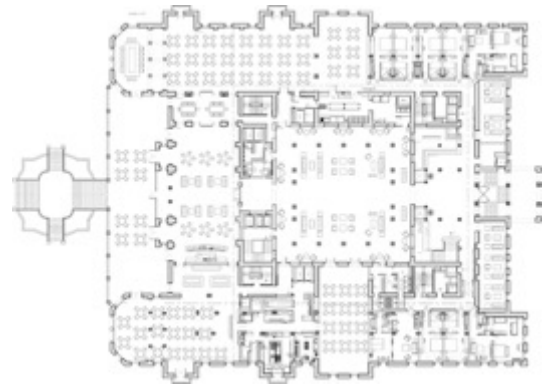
Planta tipo Hotel Miramar. Fuente: Jose Seguí Pérez.
